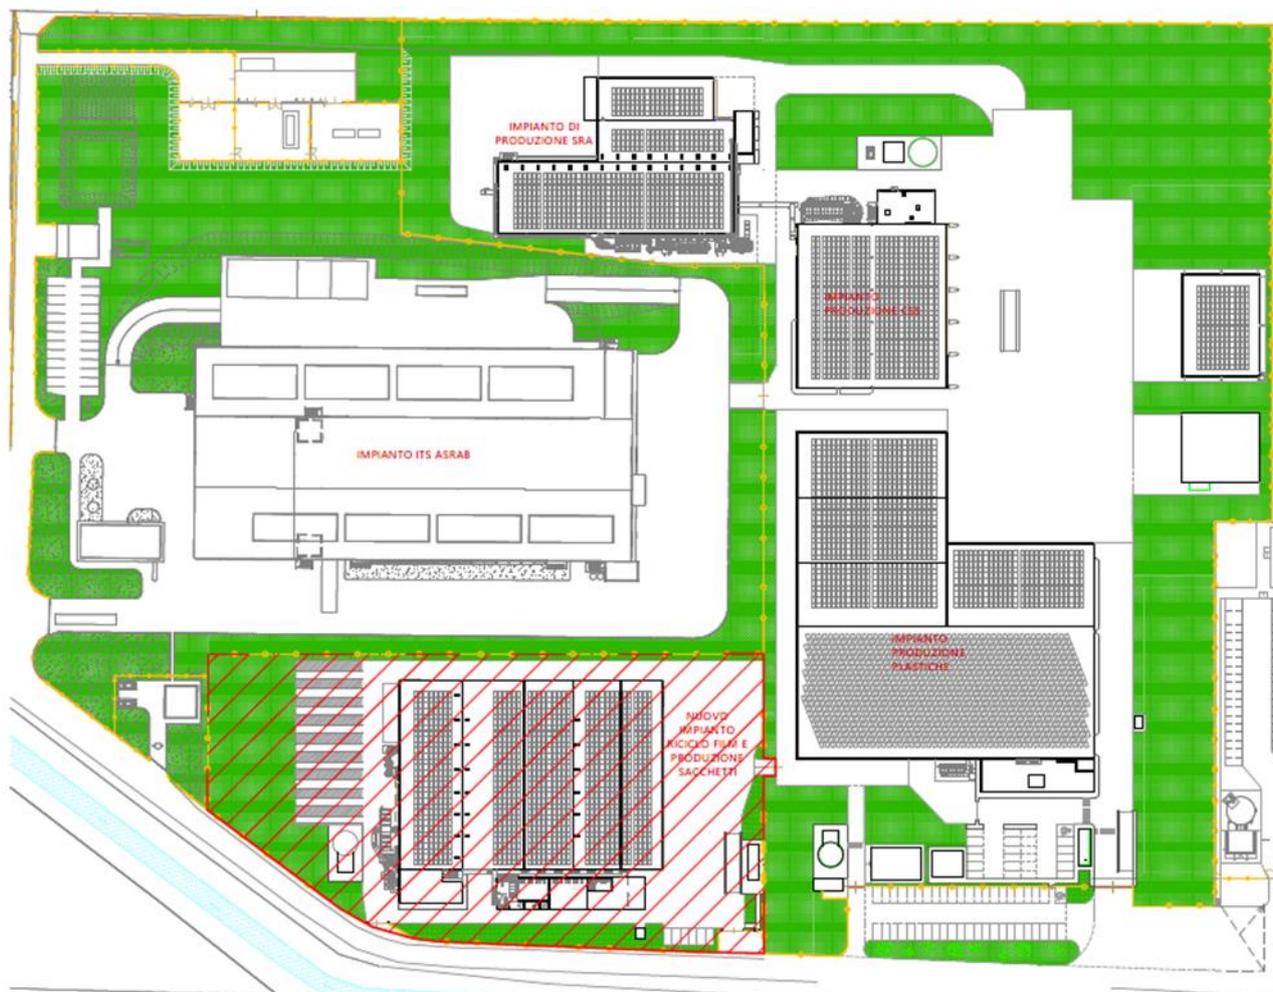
Planimetria generale degli impianti esistenti con l'indicazione delle nuove aree di intervento "NUOVO IMPIANTO RICICLO FILM E PRODUZIONE SACCHETTI"
